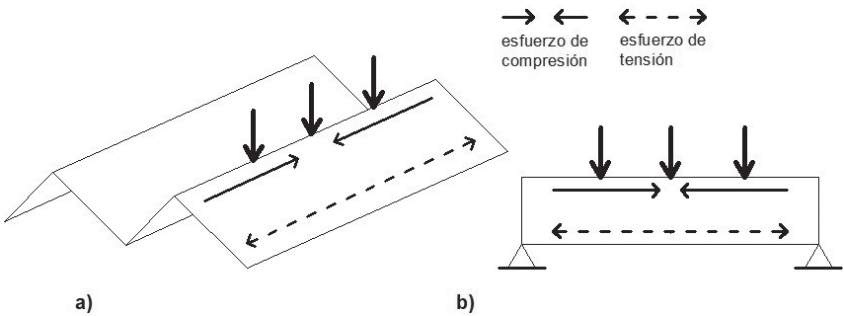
Similitud en el comportamiento de las losas plegadas y las traveses.
